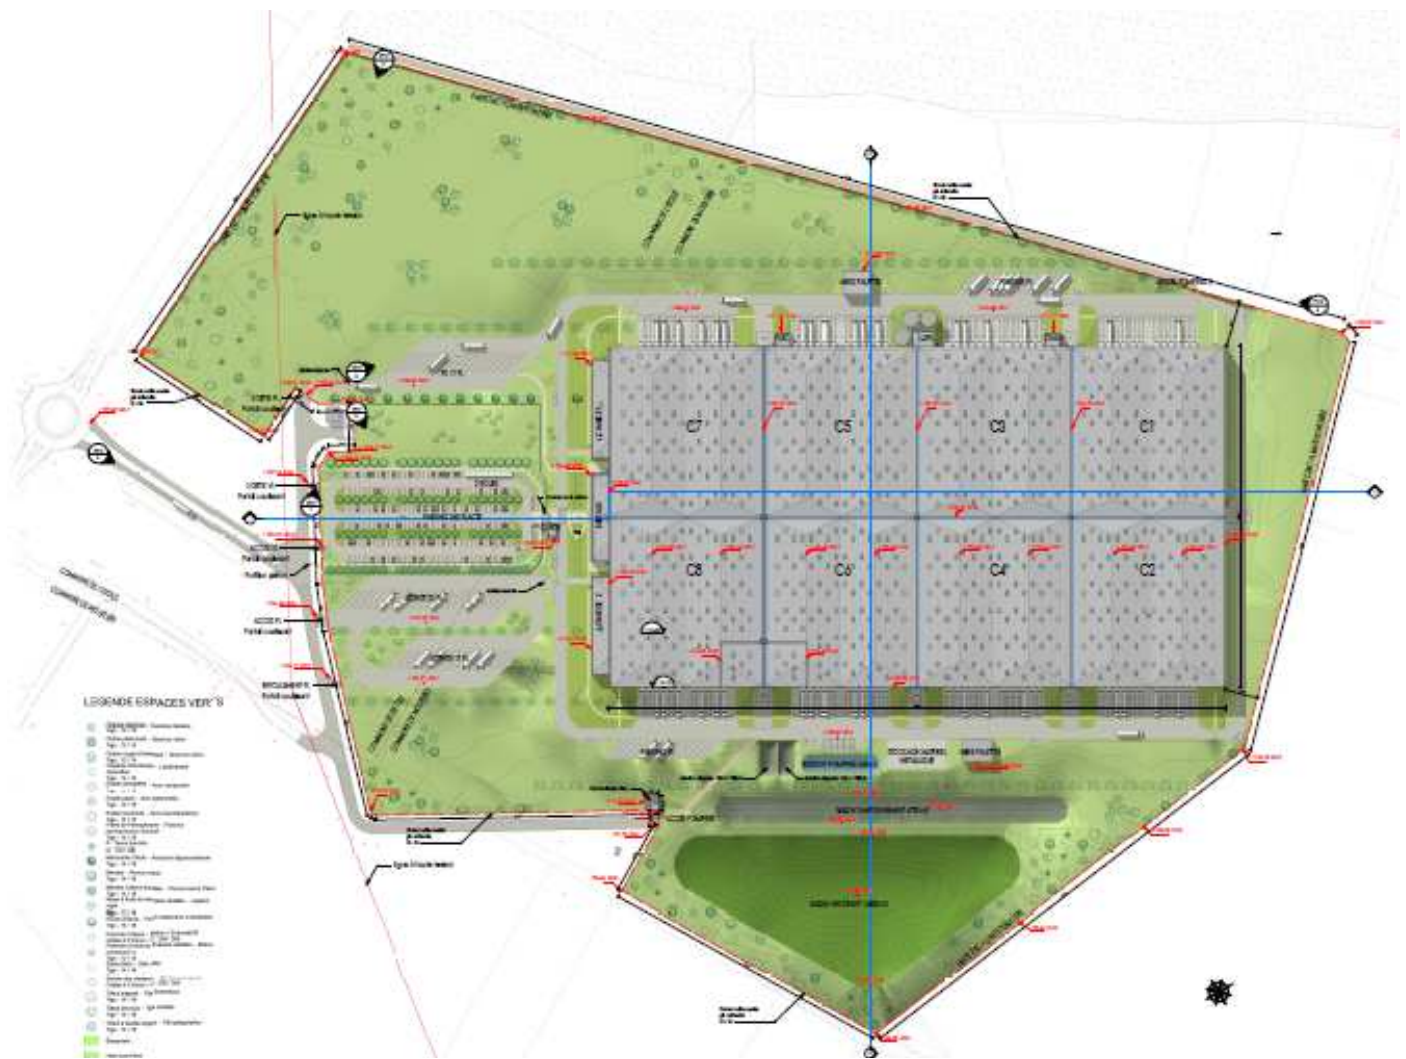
Plan de masse des installations de la plateforme logistique JJA
